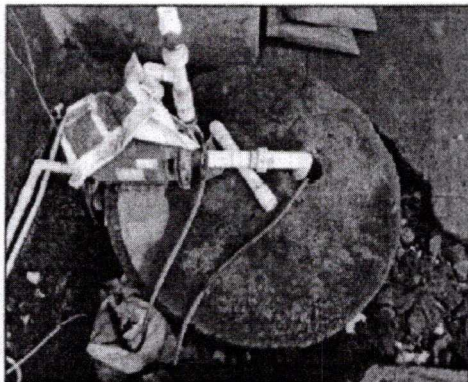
Aljibe de abastecimiento y equipo de bombeo instalado en lavadero Lavacar.
